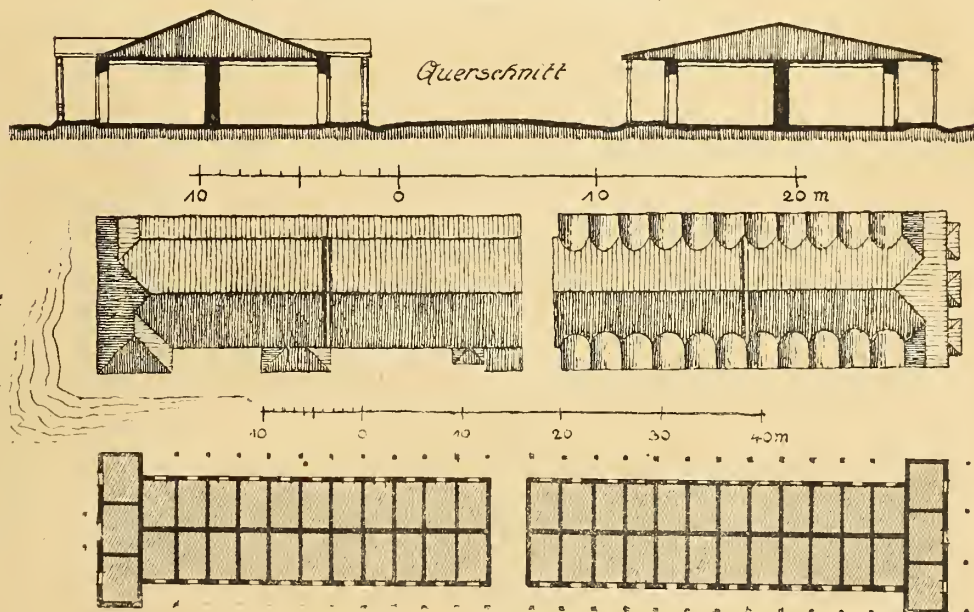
Pinsk. Grundriß, Dachaufsicht und Querschnitt.
